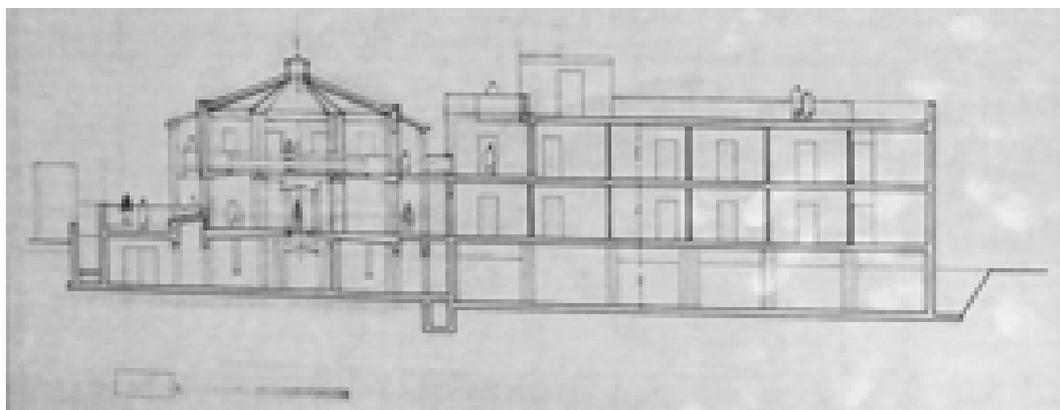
Sezione AA, stato futuro – 28/03/1995 (AABS-64_837)
